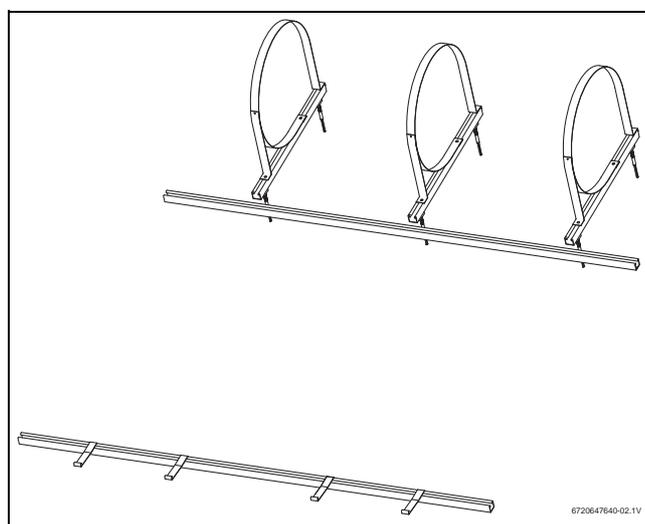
Vista geral da instalação para telhados inclinados (aquí, sistema de 300 l)
